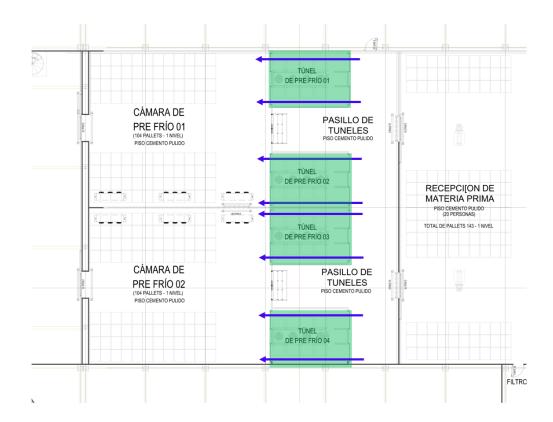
Ejemplo de aplicación de sistema FIFO en zona de pre frío de la Planta Empacadora.
